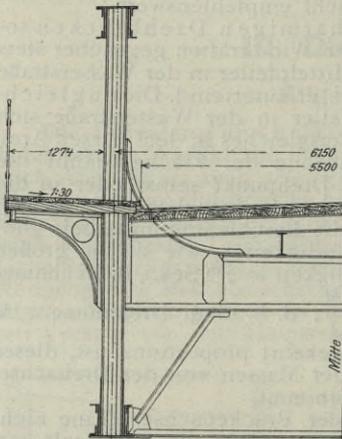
Drehbrücke mit Fahrbahn in halber Höhe. (Straßenbrücke bei Rendsburg.)
